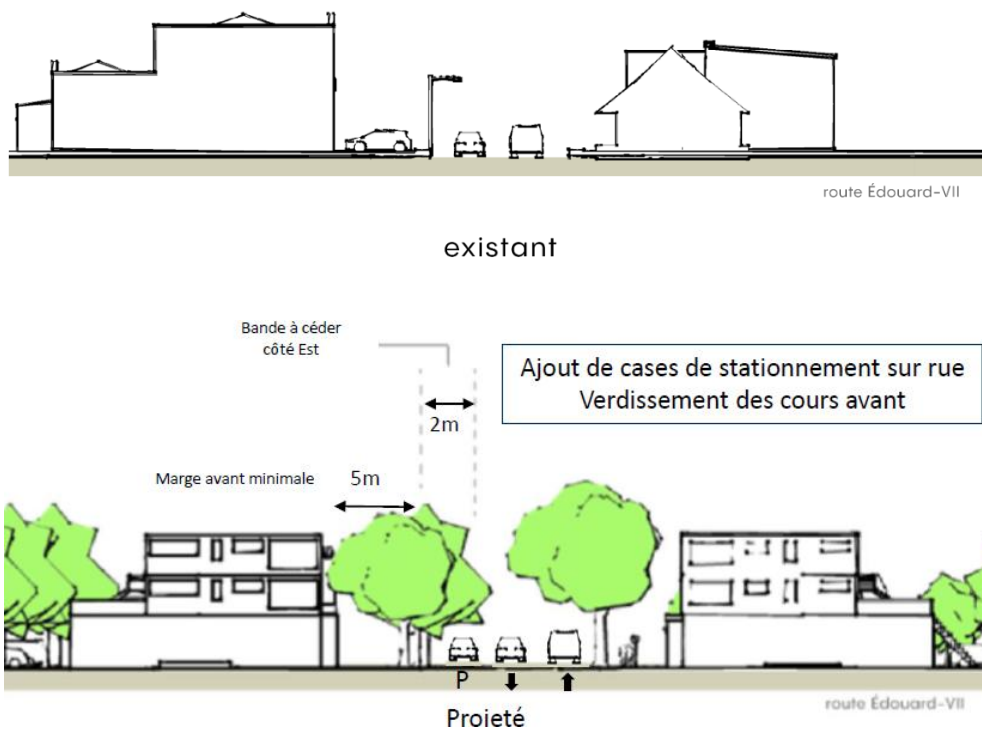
Route Edouard VII, coupes de rue (conditions existantes en haut et projetées en bas) illustrant la largeur supplémentaire de la chaussée, la largeur de terrain à céder et le stationnement sur rue
